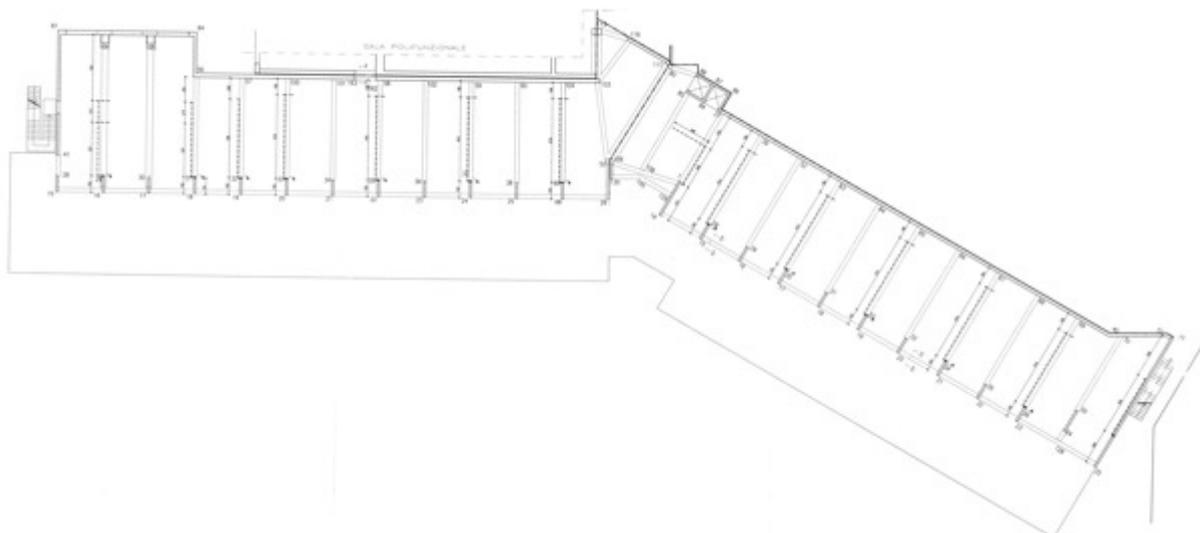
Carpenteria secondo solaio (Progetto originale delle strutture oggetto di demolizione – BLOCCO B1 e B2).
